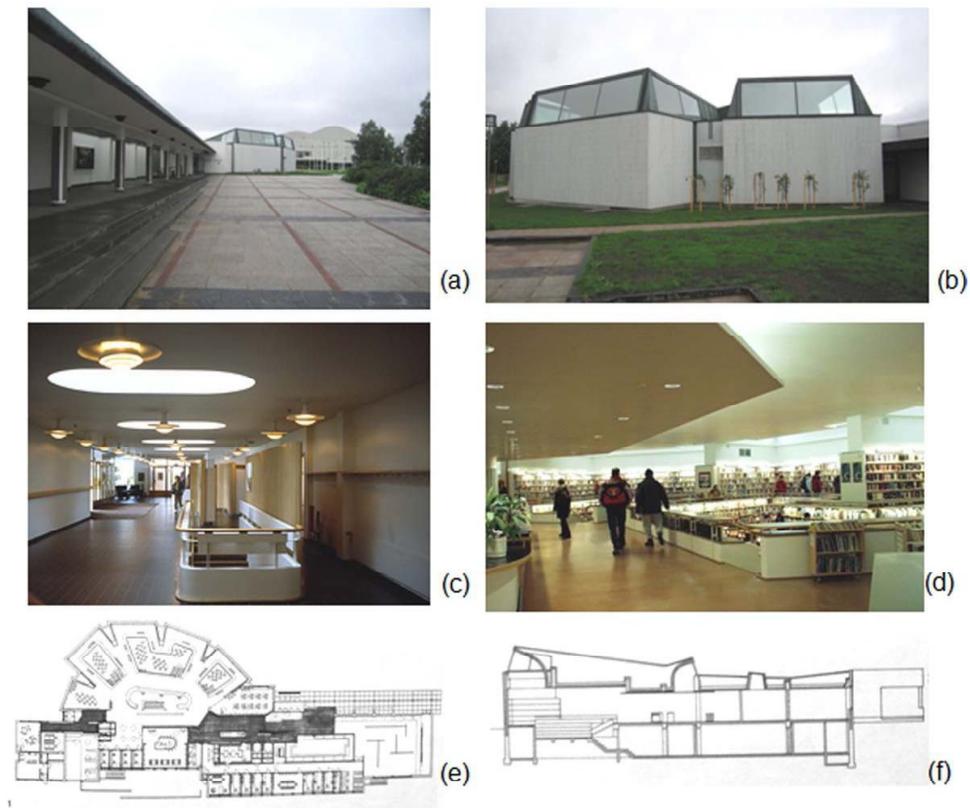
Alvar Aalto, Biblioteca Pública de Rovaniemi, Finlandia, (1963-1968): (a), (b) Vistas exteriores, (c) Vestíbulo, (d) Detalle interior de la gran biblioteca, (e) Planta arquitectónica, (f) Sección transversal.
